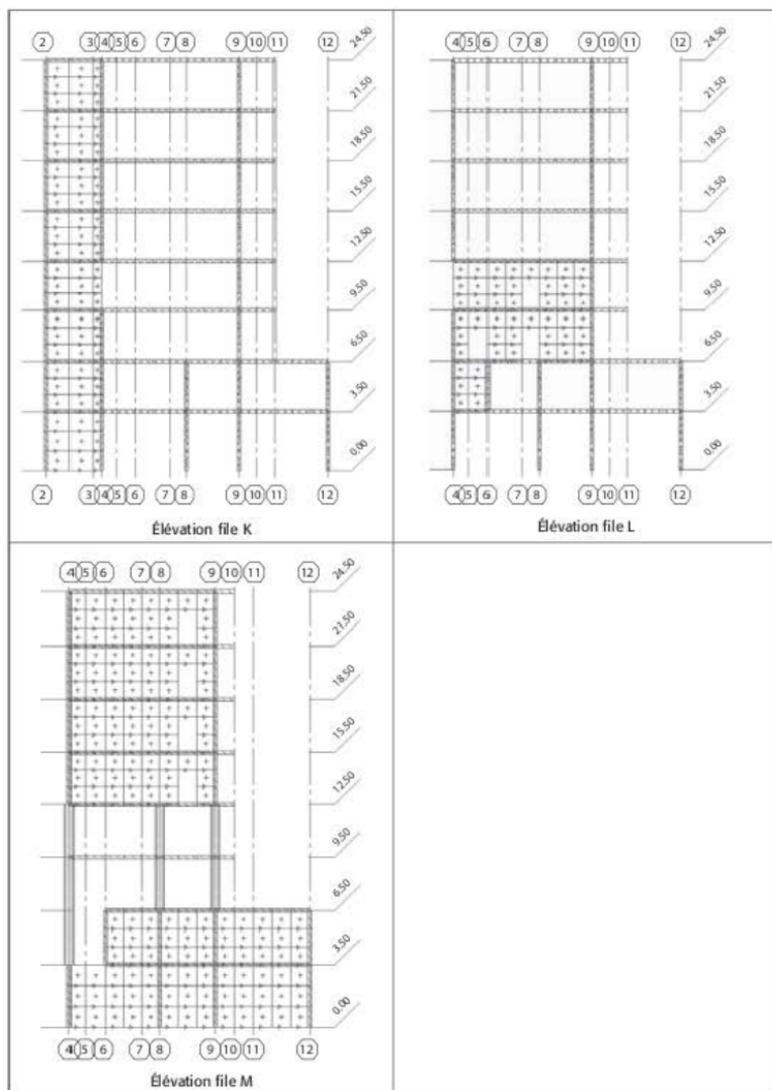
Élévation des voiles – plan XZ (4/4)
